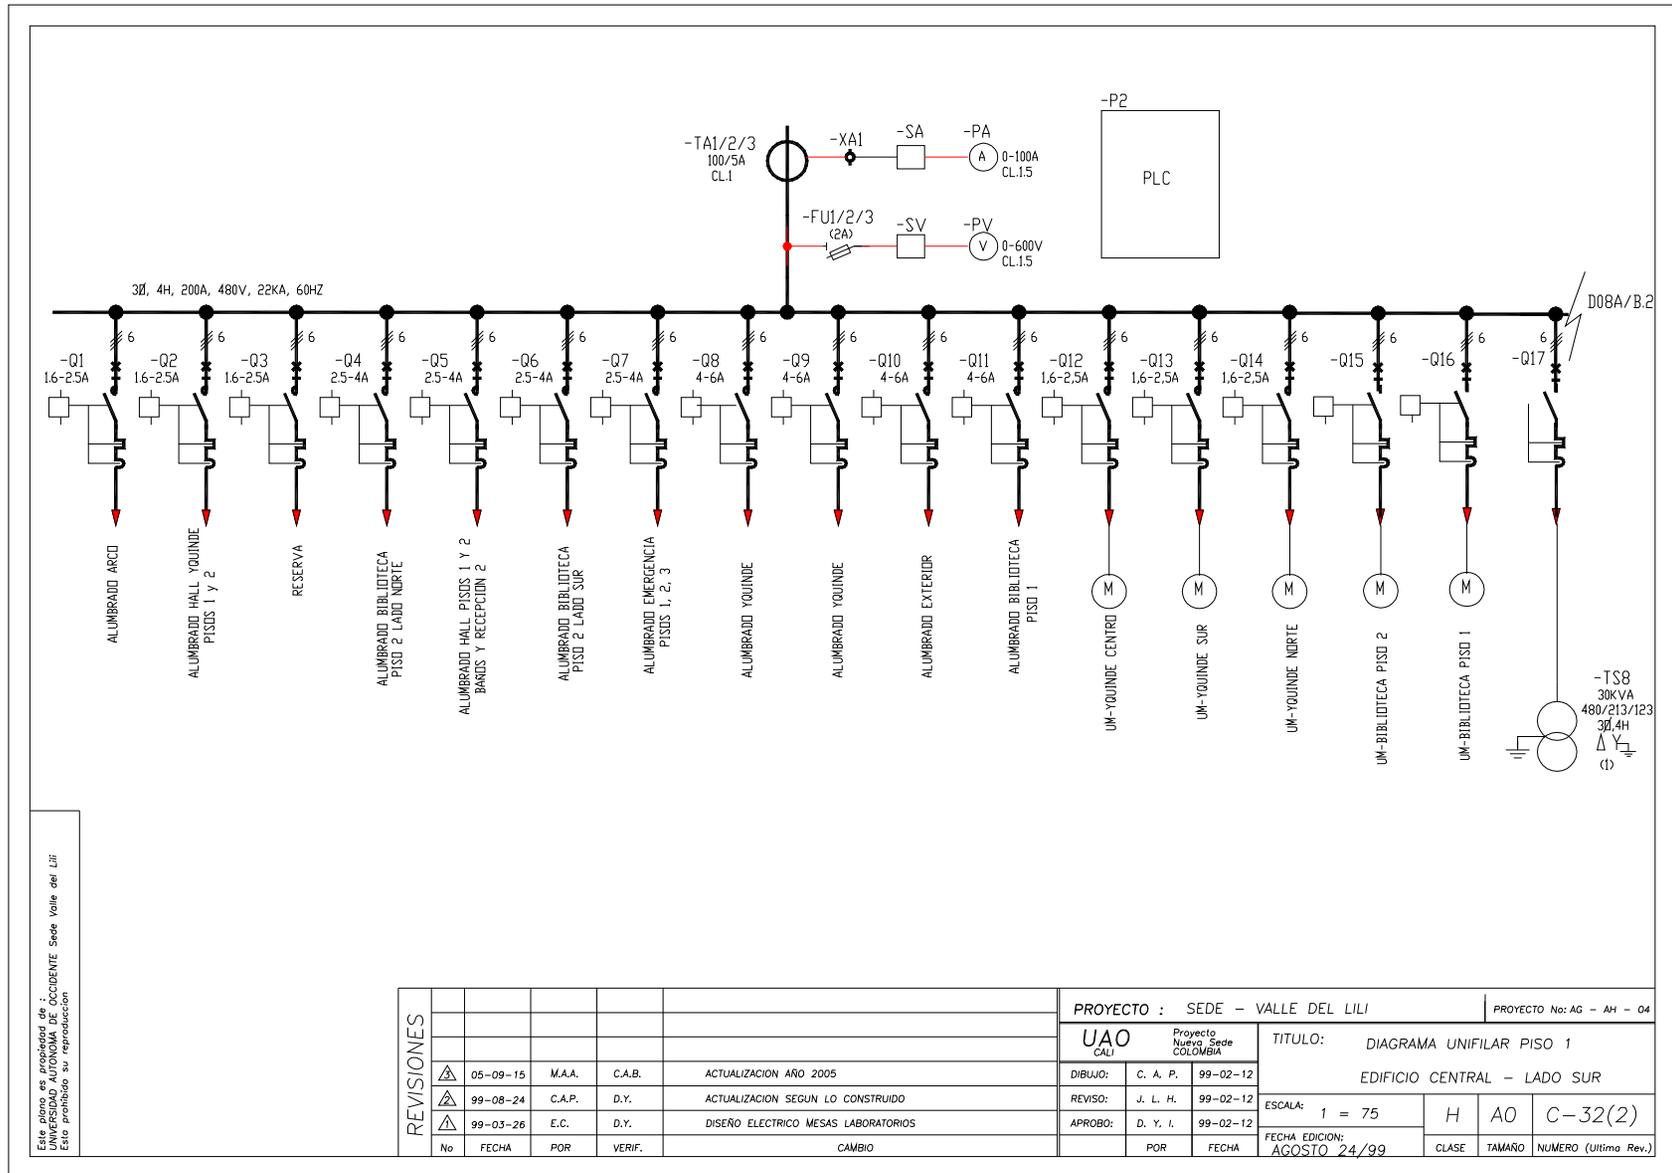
Tablero de Distribución Ed. Central piso1 lado sur
